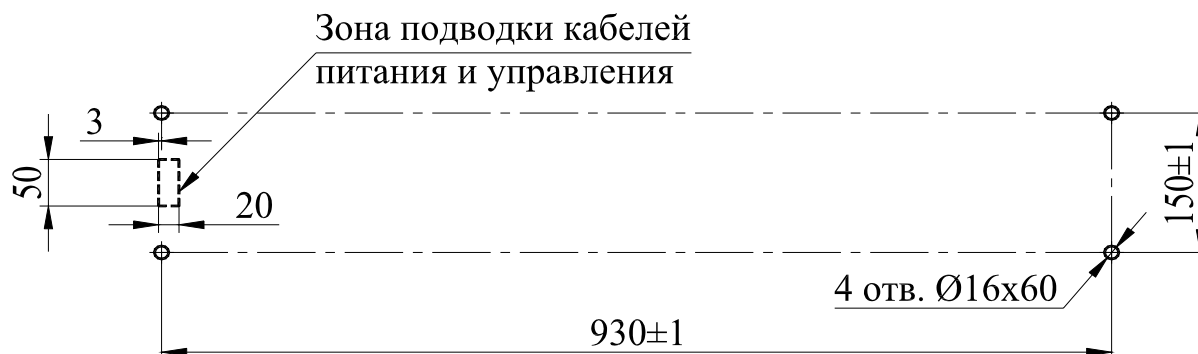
Схема разметки отверстий для крепления стойки турникета
